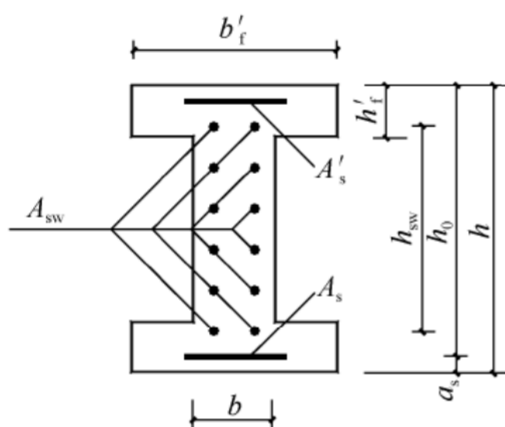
沿截面腹部均匀配筋的 I 形截面
